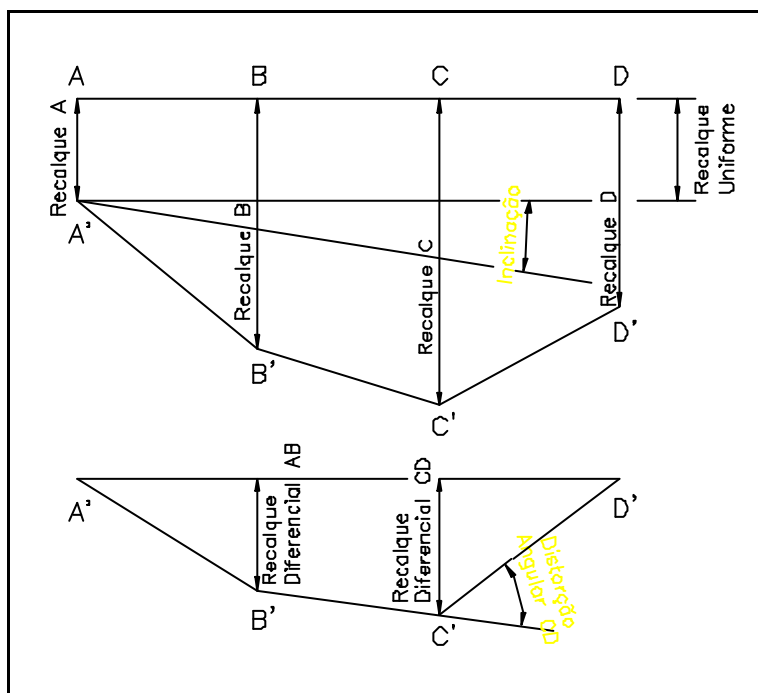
Tipos de Movimentos de Fundação, GRANT et al. (1974) apud HACHICH et al. (1998).
